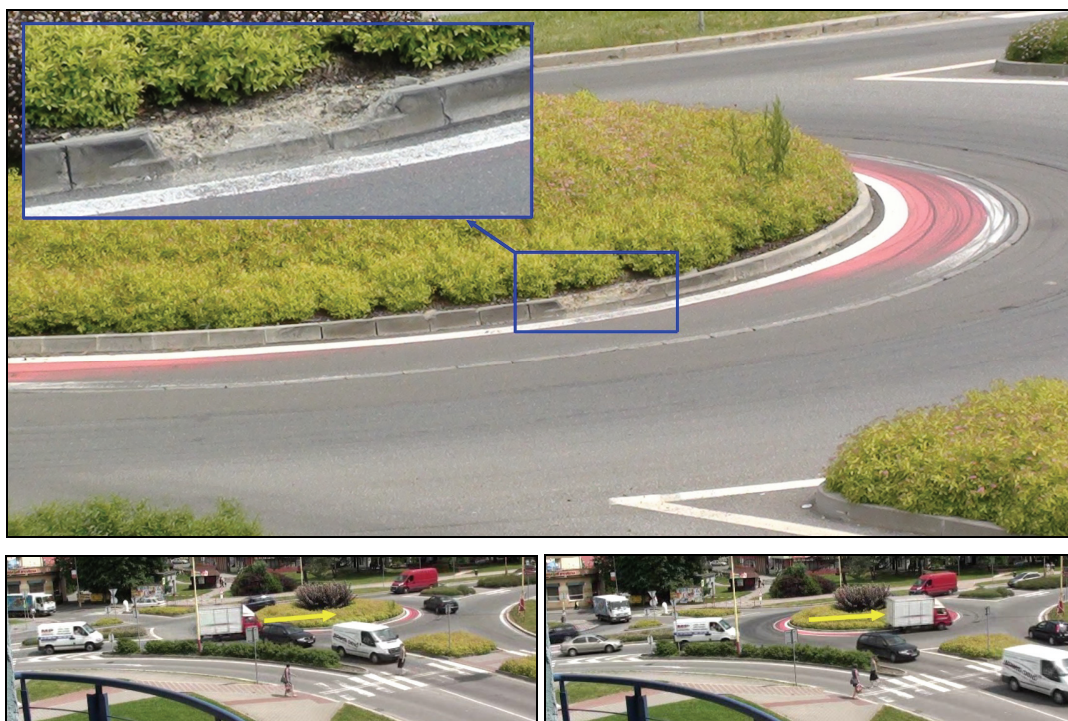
Detailními pohledy na porušený obrubník na výjezdu z okružní křižovatky Masarykova – parking Tesco ve Valašském Meziříčí
